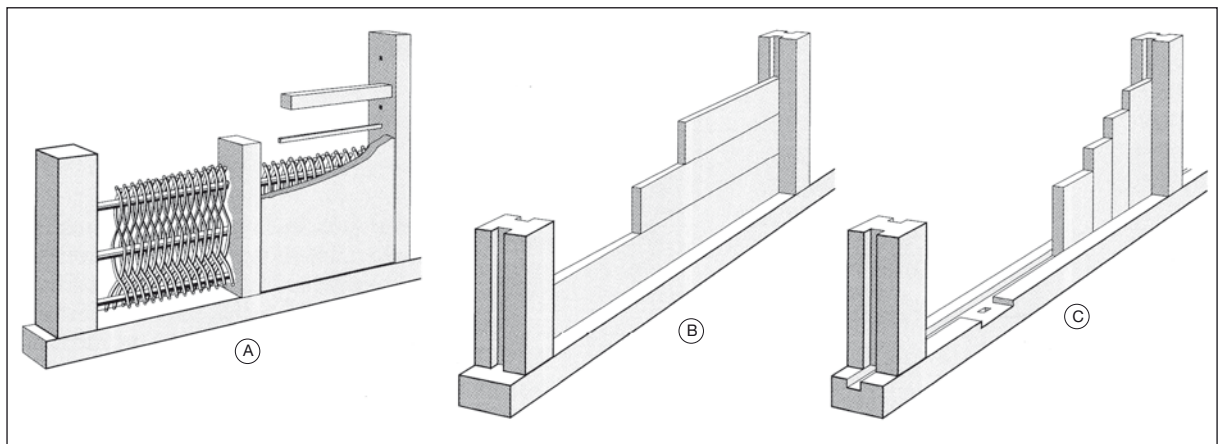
Types de parois mis au jour sur le site d'Oberwinterthur
